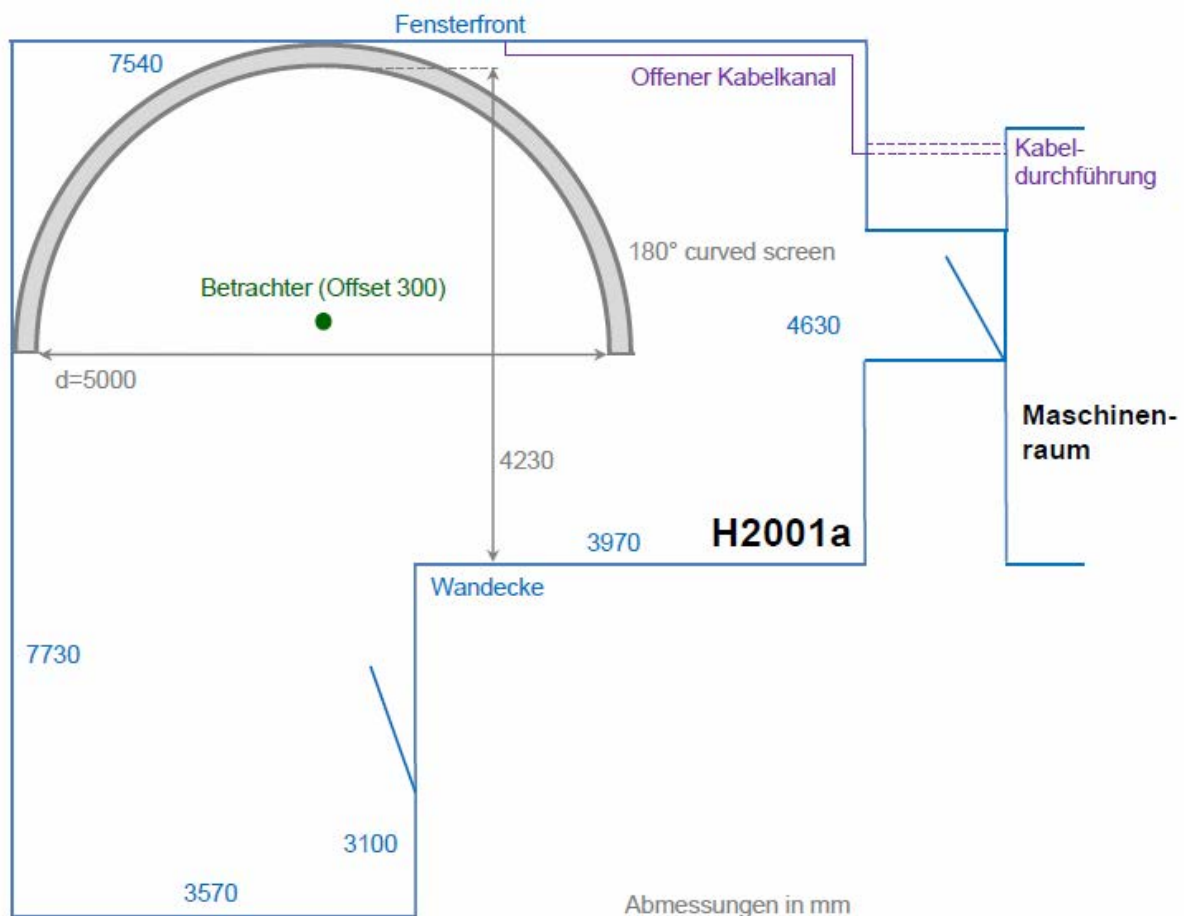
Grundriss der CAVE am Fachbereich Audiokommunikation der TU Berlin
